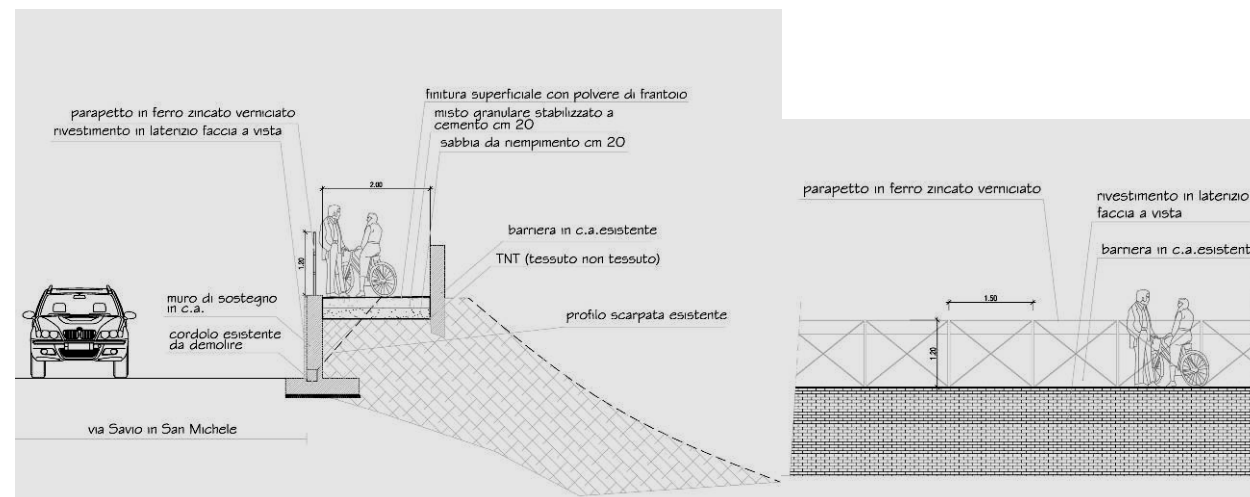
Sezione e prospetto tipo ciclovía tratto in affiancamento a Via Savio in San Michele
